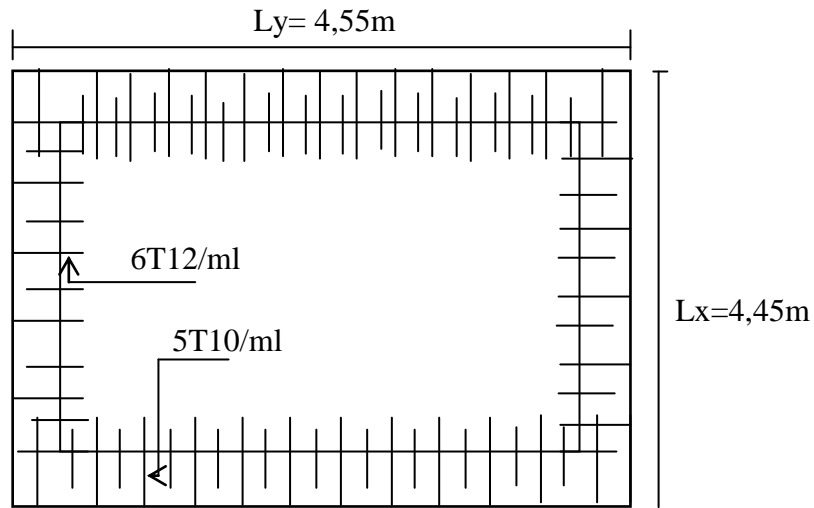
Dessin Ferrailage Supérieur du panneau de la dalle pleine.
